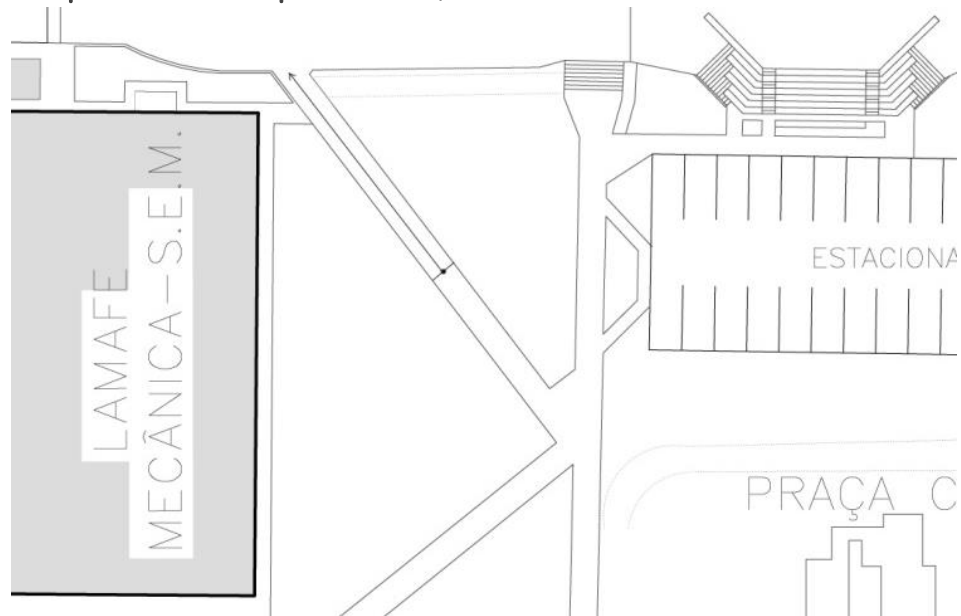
Planta da rampa de acesso. Fonte: Grupo 4a
